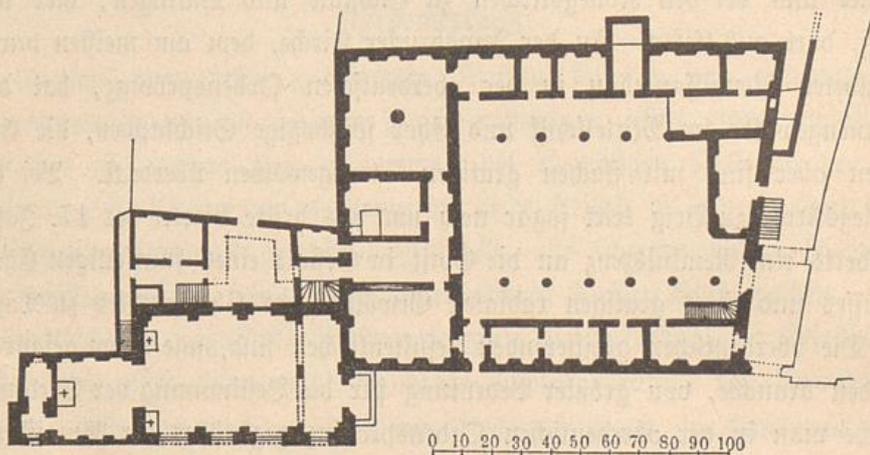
Innsbruck. Kolleg und Kirche, Grundriß. (Nach Originalgrundriß.)
